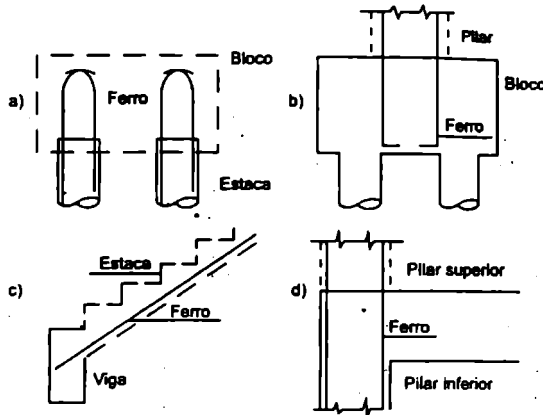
Utilização de barras de "espera" na ligação de peças estruturais de concreto.
